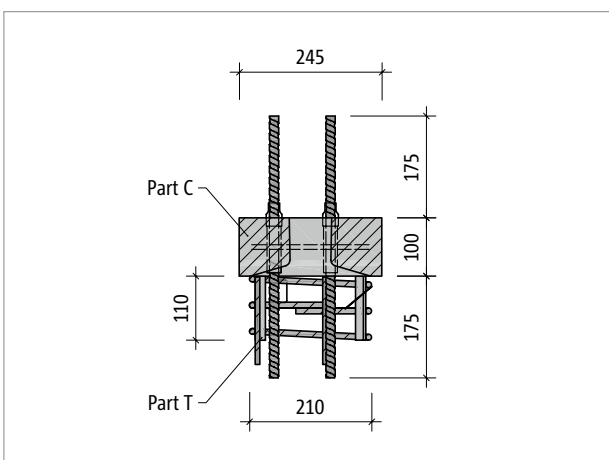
Schöck Sconnex® type P-B250: Aanzicht van bovenaf
